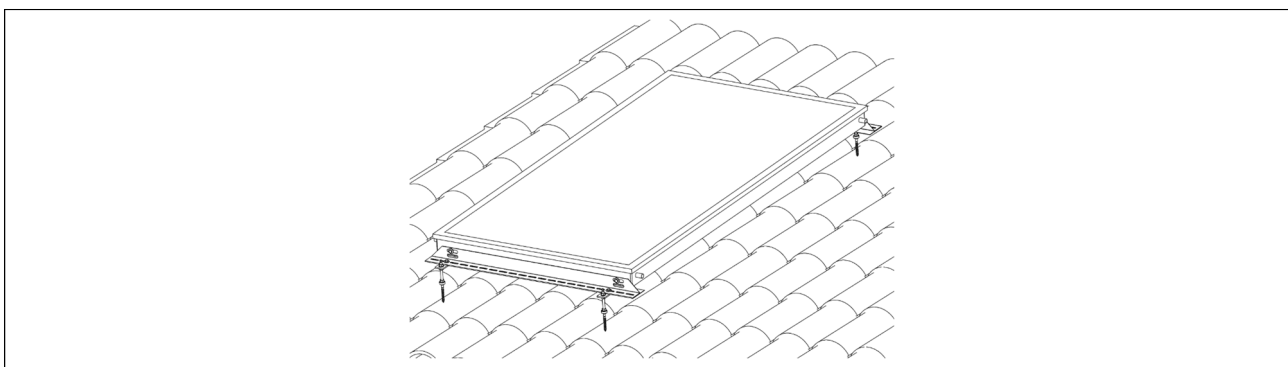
Installazione su tetto inclinato con viti prigioniere
